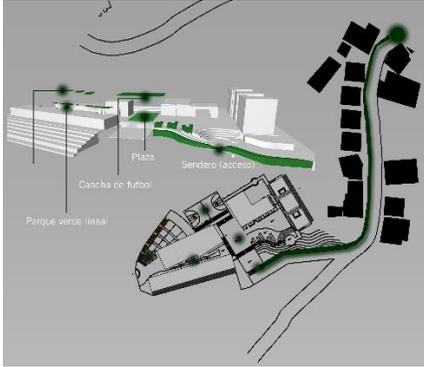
PLANIMETRIA INSTITUTO EDUCATIVO AGRICOLA ALTO CAUCA EXISTENTE.
